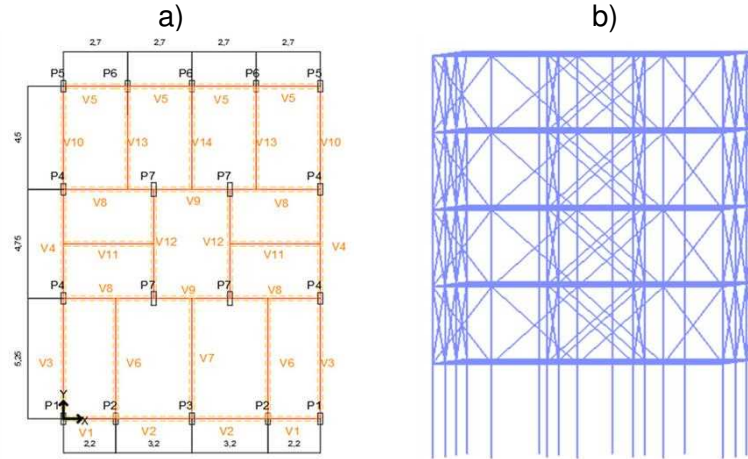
Representação do Edifício em planta a) e em vista tridimensional b)
